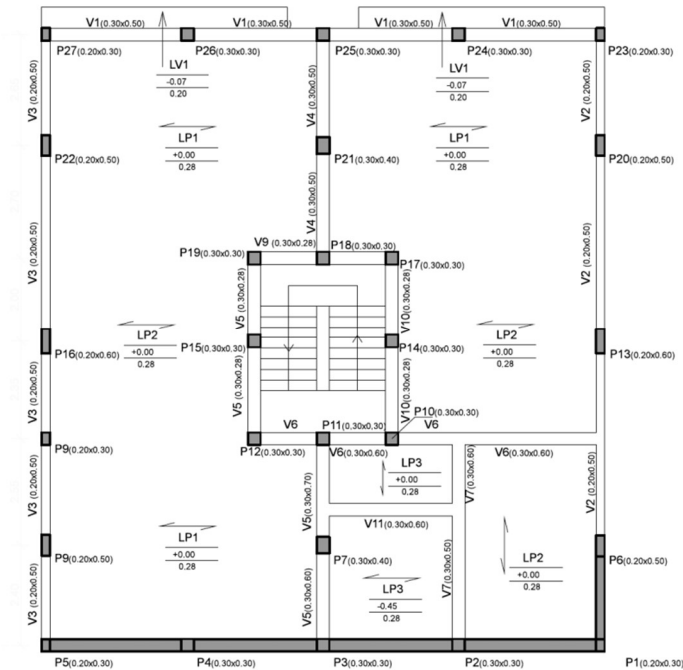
Planta Estrutural Bloco 2-0 (Semelhante aos Blocos 3 e 4).
